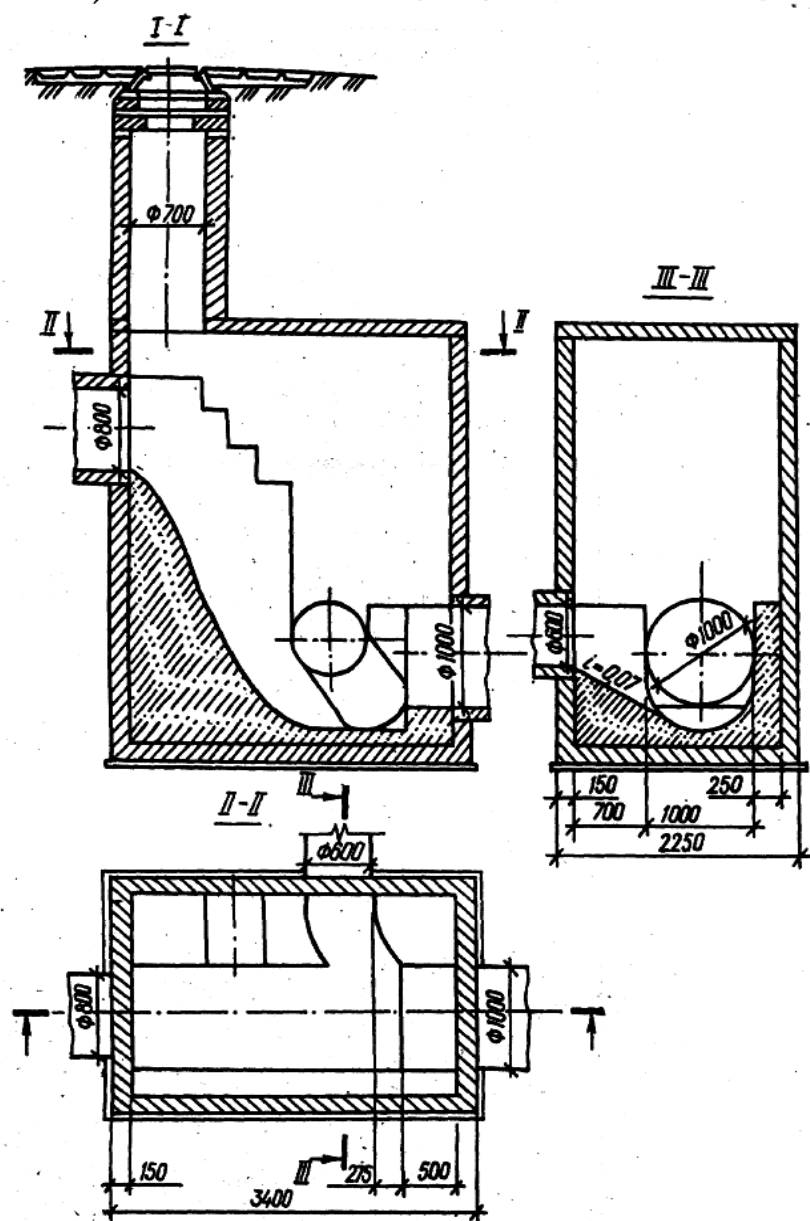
Перепадний колодязь із залізобетонним каналом
